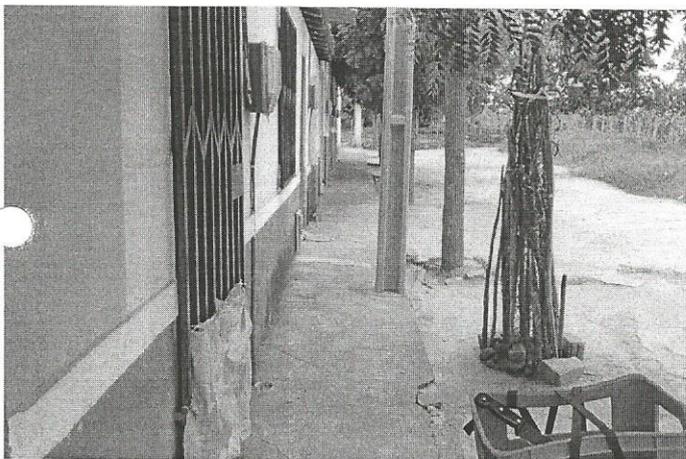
RUA S.D.O. 05 (CALÇADA EXISTENTE 02)
